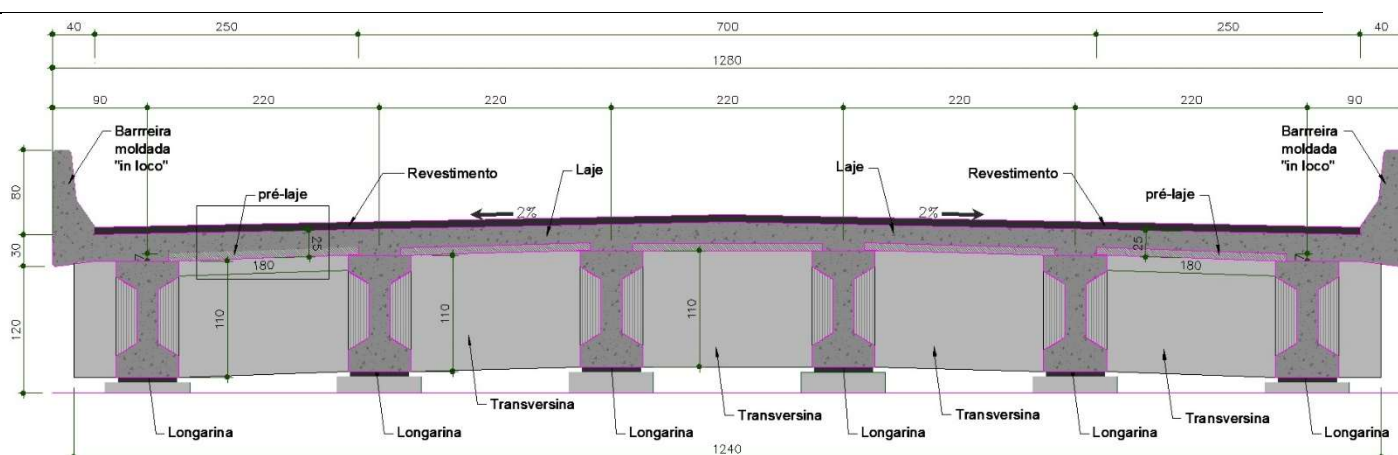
concepção da seção típica e seu pré-dimensionamento.
